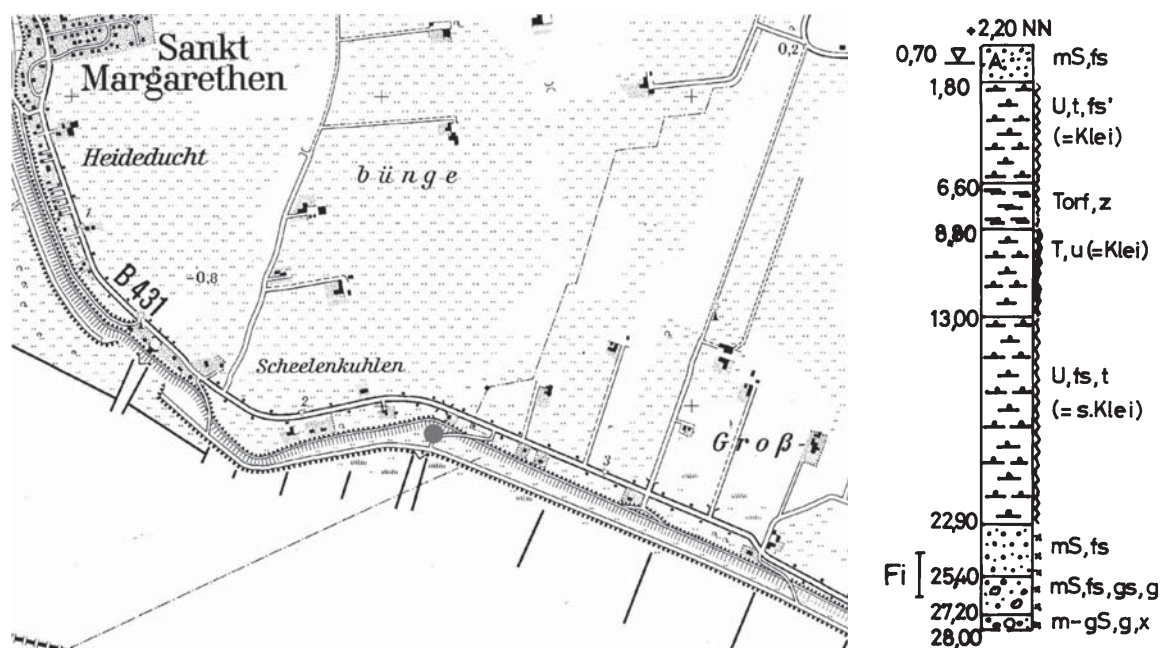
Lageplan und Bohrprofil am Deichsiel St. Margarethen – Harrwettern
